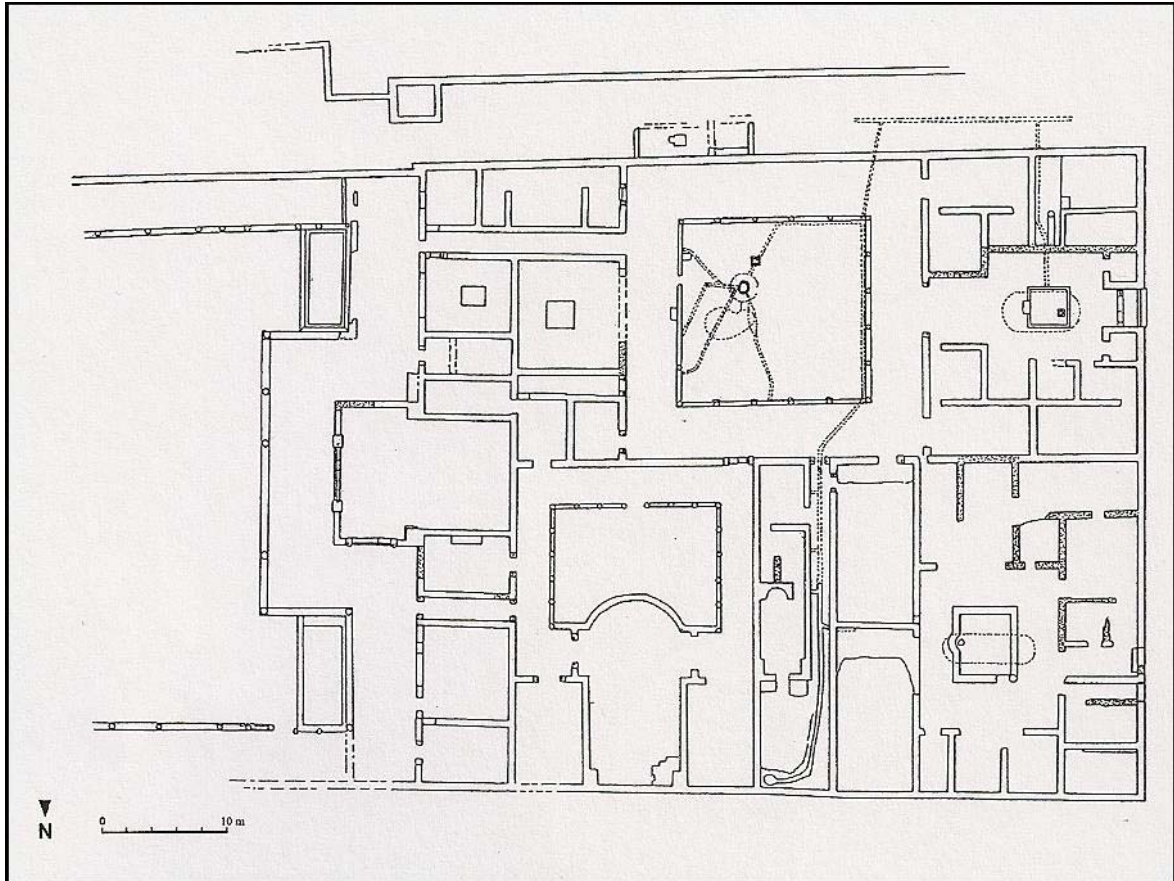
Planta de la gran casa republicana de la zona baja. en *Contrebia Belaisca* (Zaragoza) según Beltrán 1991: 184. 1. Calle bien pavimentada en el punto de acceso a las casas 22. 2. Lugar de la calle reparada con media piedra de molino giratorio. 3. Vestíbulo. 4. Cubículo. 5. Sala. 6. Corredor principal. 7. “Panadería” o estancia con molinos. 8. Gran habitación de la zona agrícola. 9. Estancia intermedia entre las habitaciones privadas y el atrio. 10. Ala. 11. Atrio. 12. *Tablinum*. 13-14. Corredor a inferior nivel que la vivienda donde se hallaron molinos apoyados en el muro de piedra de separación de las dos zonas. 15. Patio, centro de la zona agrícola, donde se halló el “bronce de Botorría”. 16. Zona de recepción o gran zaguán de la parte agrícola. 17-18. Obradores y almacenes, con aljibe de harinas y depósito en grandes tinajas. 19. Calle pavimentada con guijarros. 20. Construcción de tipo celtibérico, grandes sillares de yeso, con un espacio incompleto hacia el río y una despensa o almacén al fondo. 21. Almacenes o cuadras.
